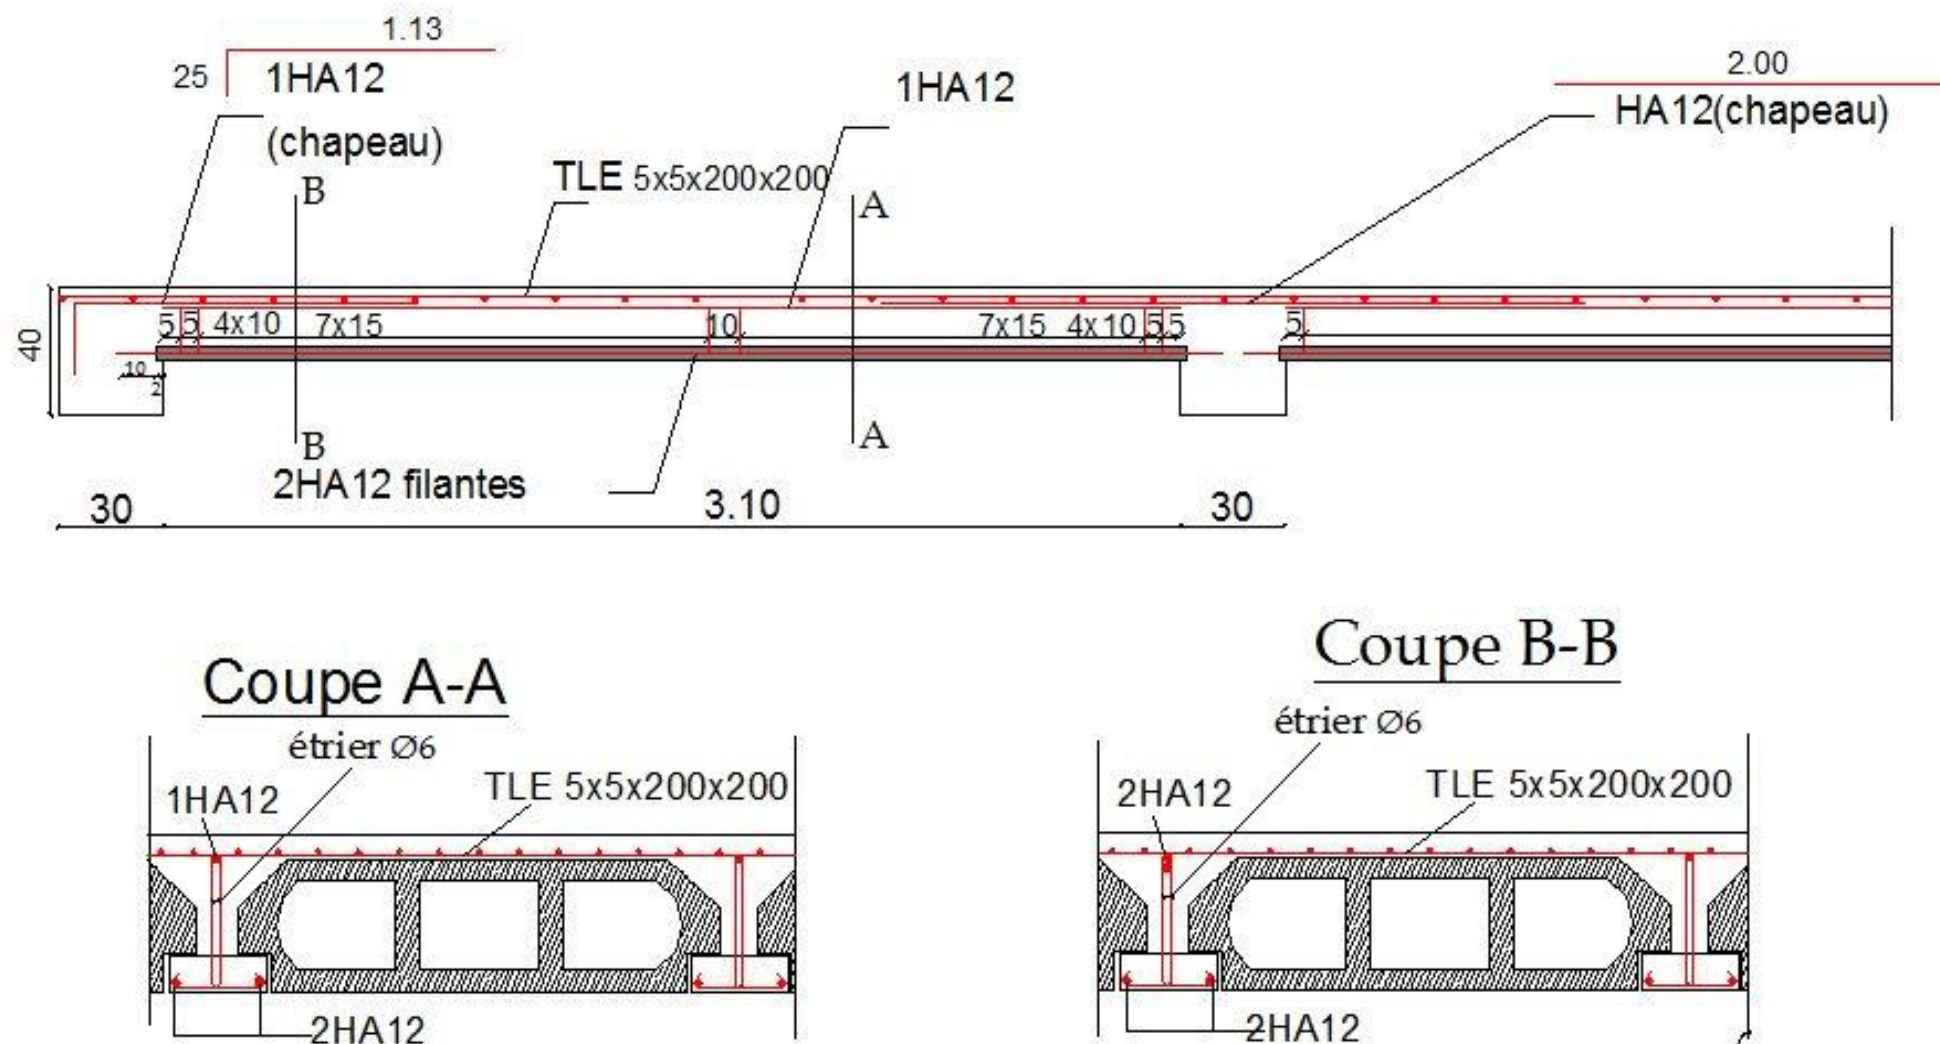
Plan de ferrailage du plancher en corps creux.
